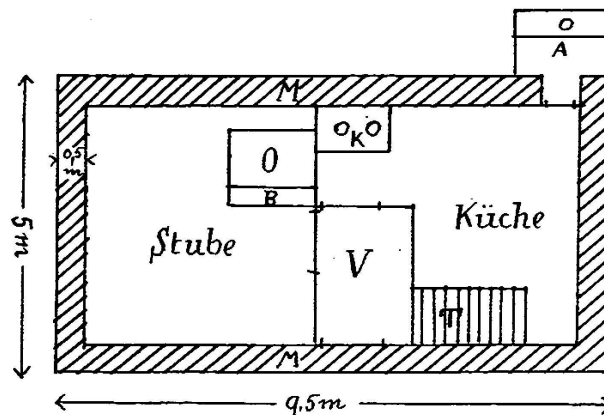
Grundriss des Hauses Nr. 12 (siehe Plan des Dorfes).
